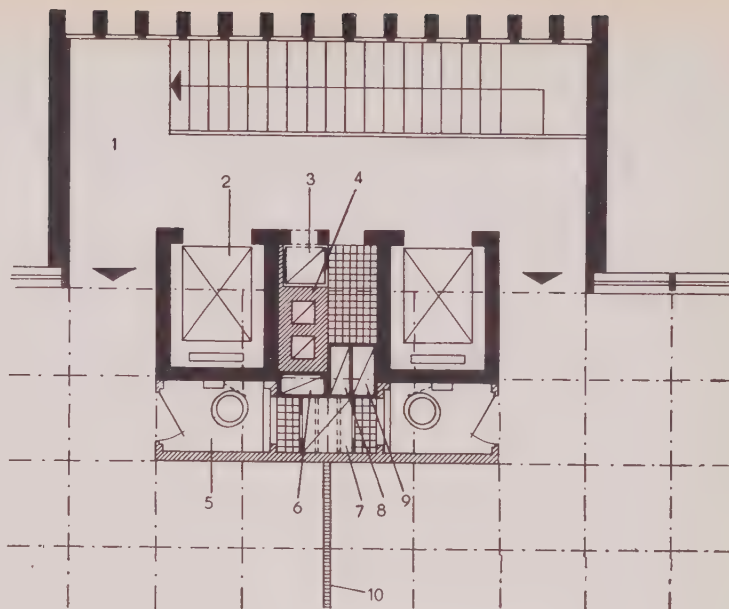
Treppenhaus mit Vertikalverbindungen 1:100
